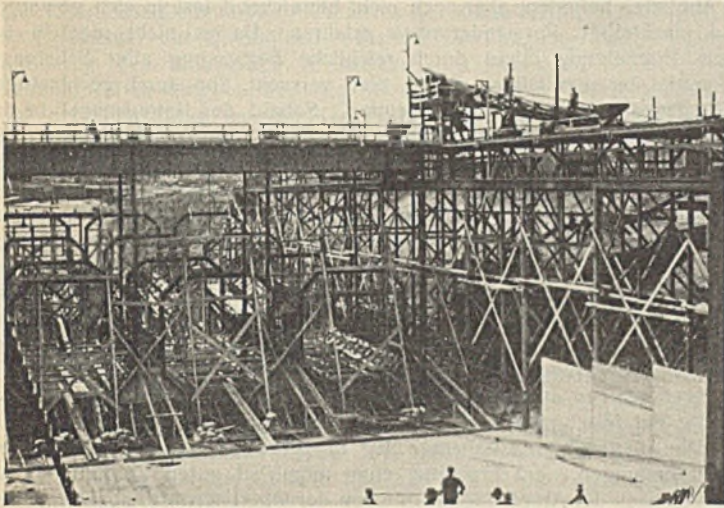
Einbringen des Betons in die Sohlenblöcke.
